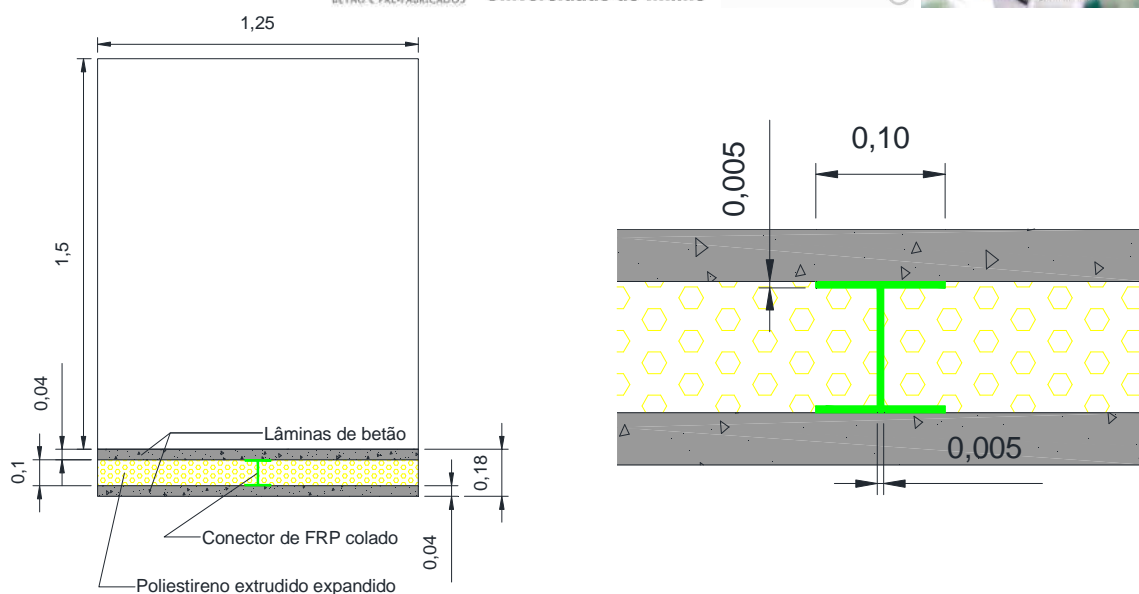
Geometria do painel sandwich com conectores perfil I colados de FRP (vista em planta e pormenor; unidades em metros).
